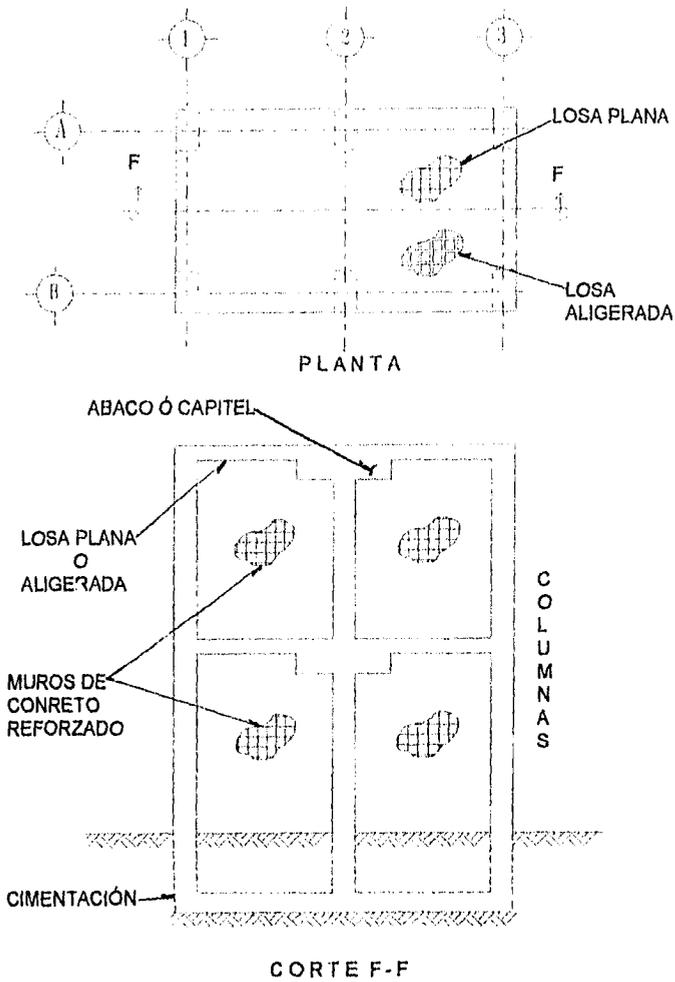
III SEXTO TIPO DE ESTRUCTURACIÓN.
